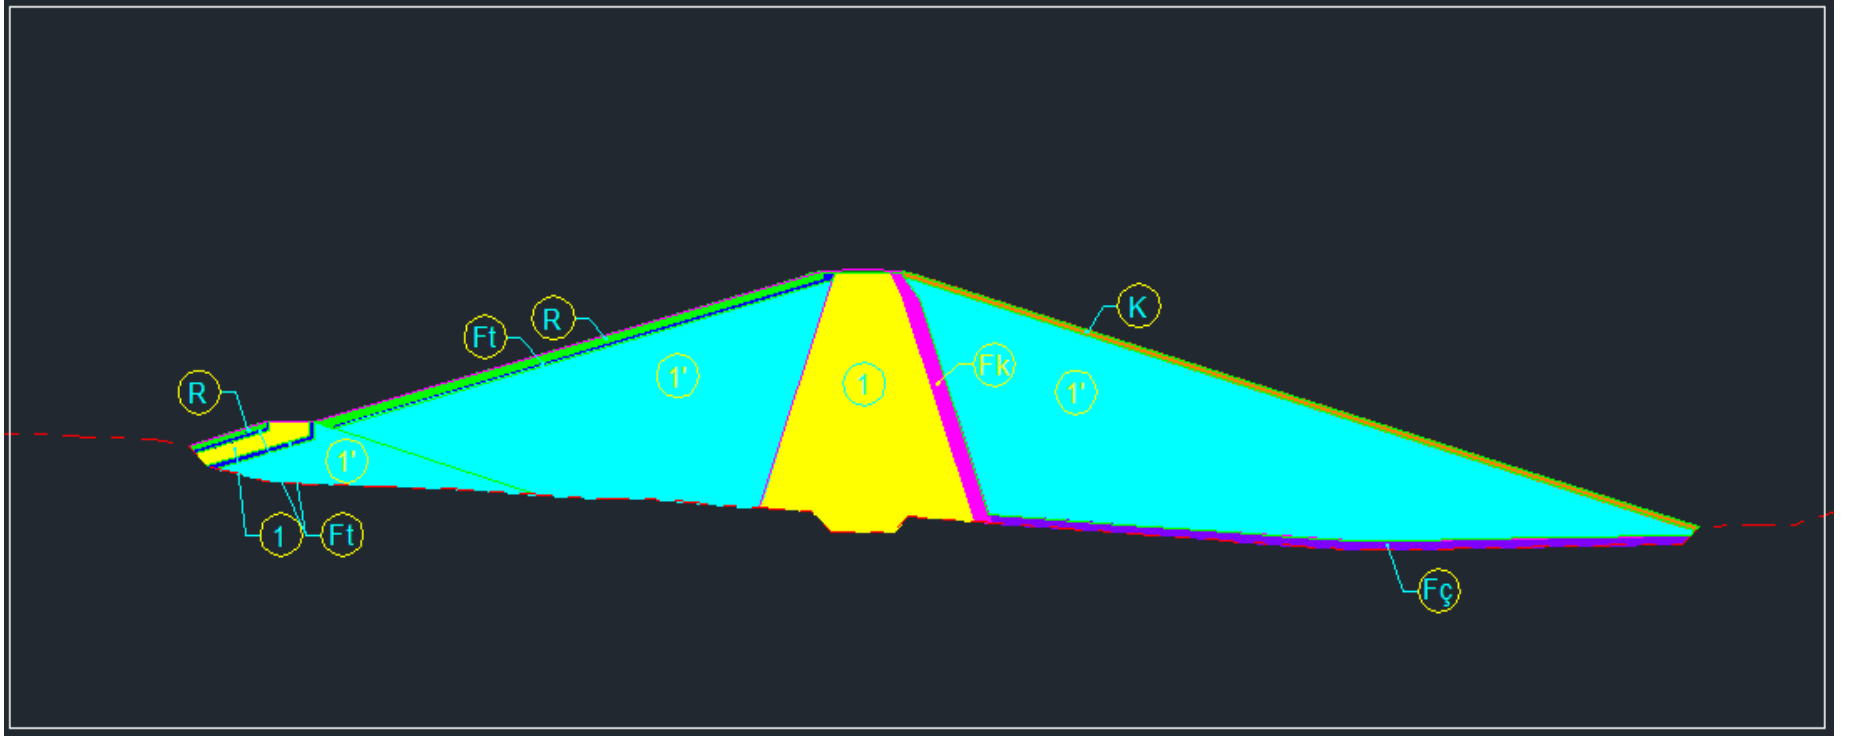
Metraj alan hesaplama – Kesit 4
